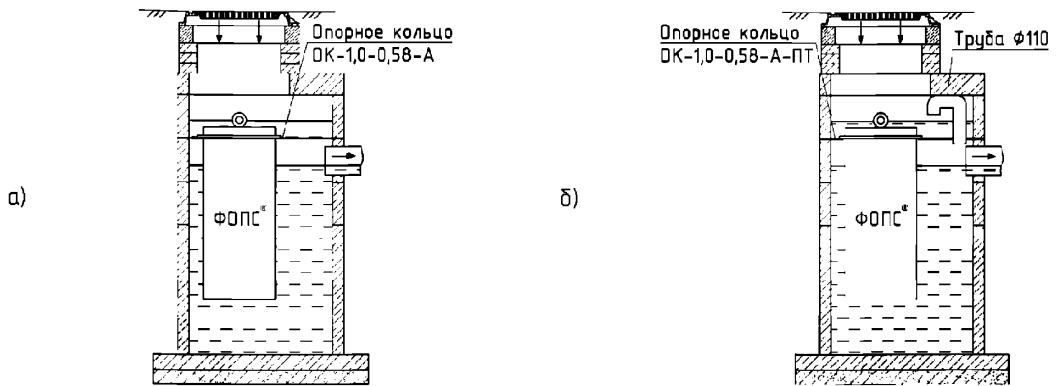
/2. Установка фильтра ФОПС® ниже плиты перекрытия:
